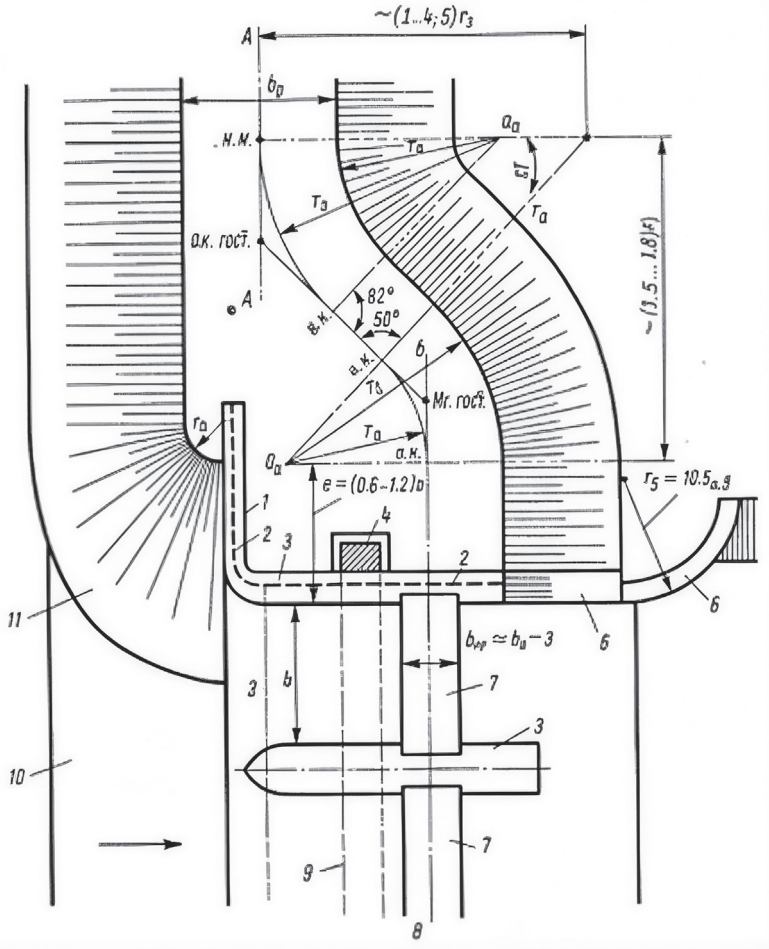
Esquema del muro de enlace de una presa de hormigón con una presa de tierra.
